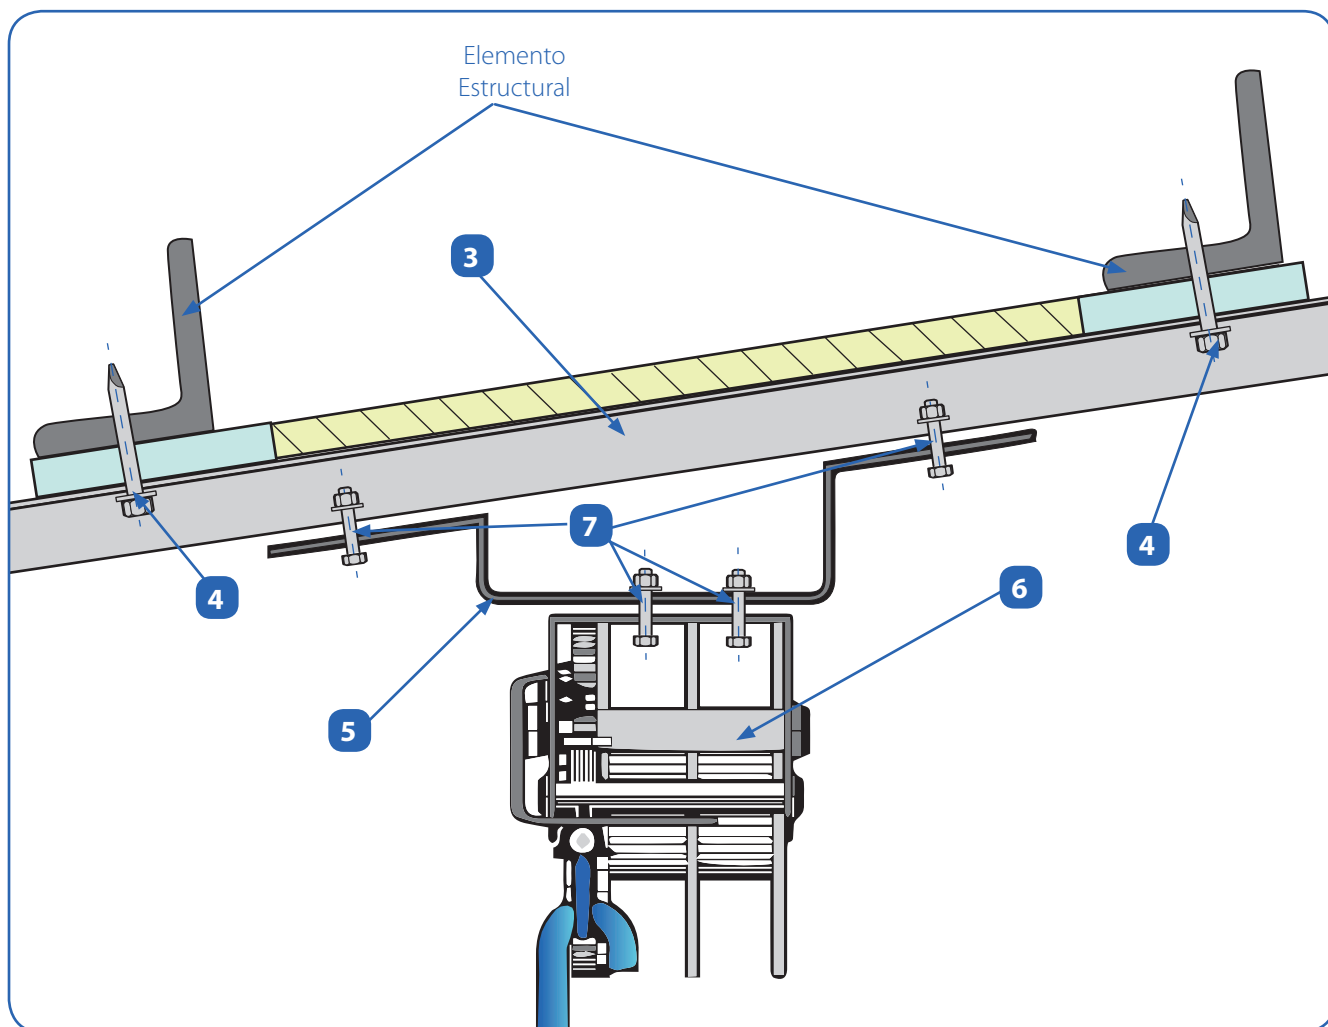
Instalación del torno en la cubierta. VISTA FRONTAL
